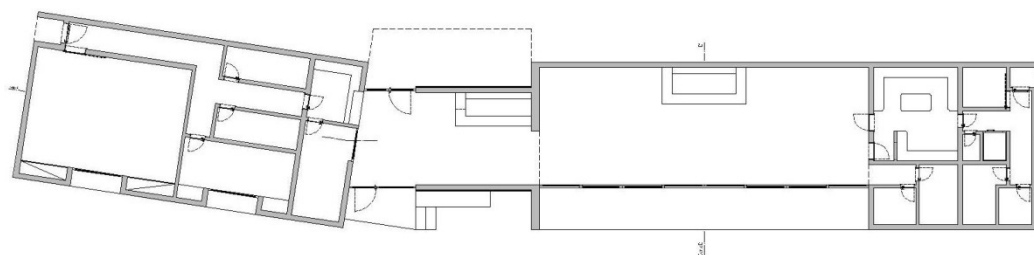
Planta do piso 0 – Edifício de recepção / serviços / restauração⁷⁵
